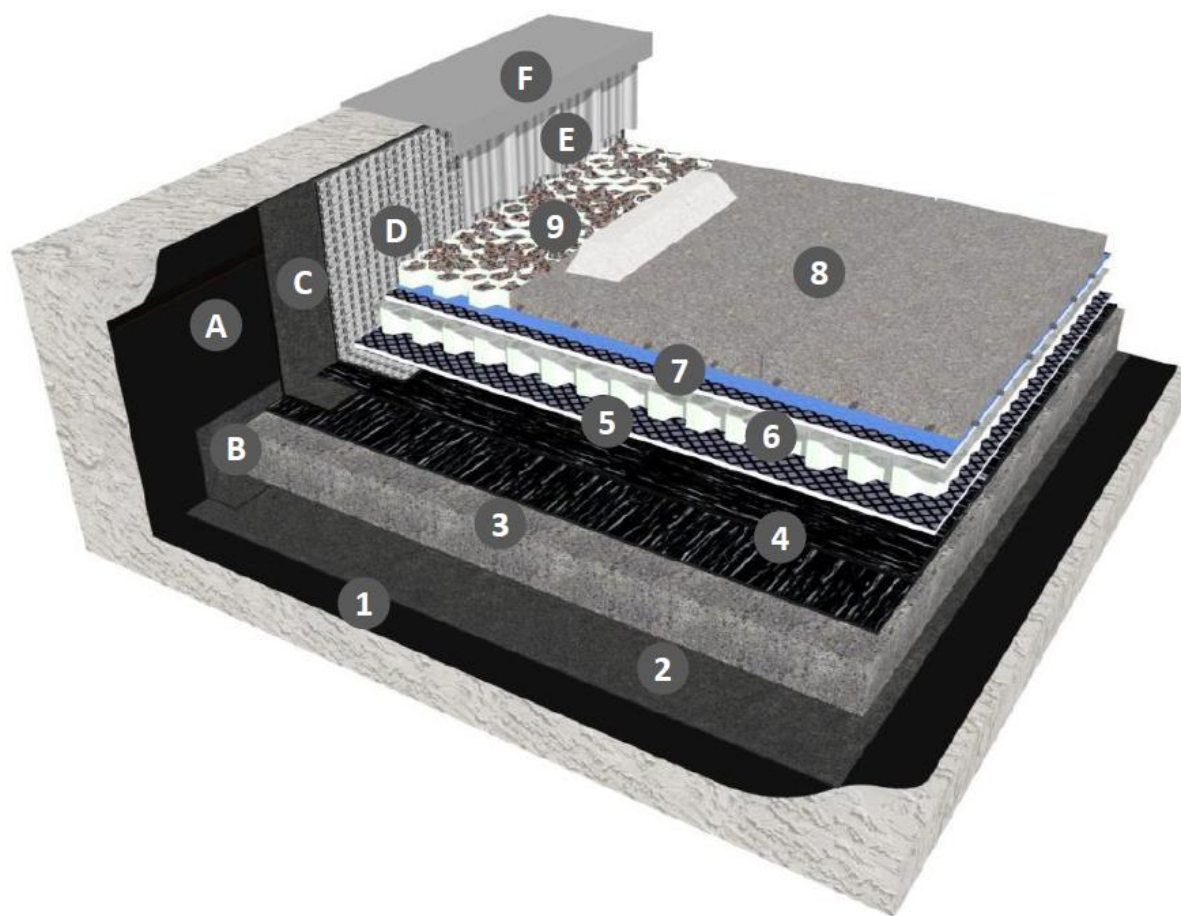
Toiture-terrasse accessible aux piétons avec protection par dallage en béton armé
